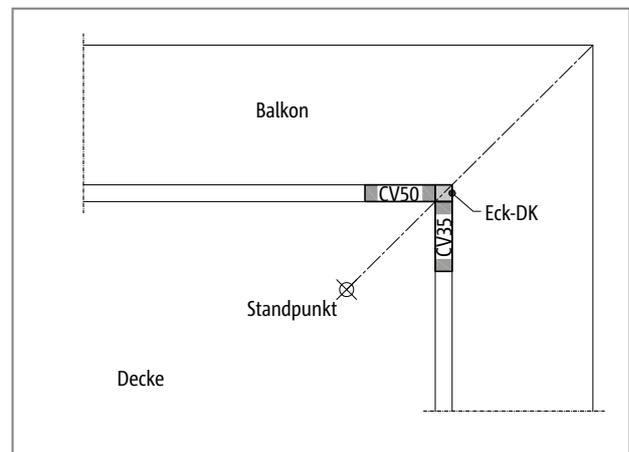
Schöck Isokorb® Typ EXT: Betondeckung wählbar: Hier CV50 links vom Standpunkt, Betondeckung CV35 rechts vom Standpunkt
